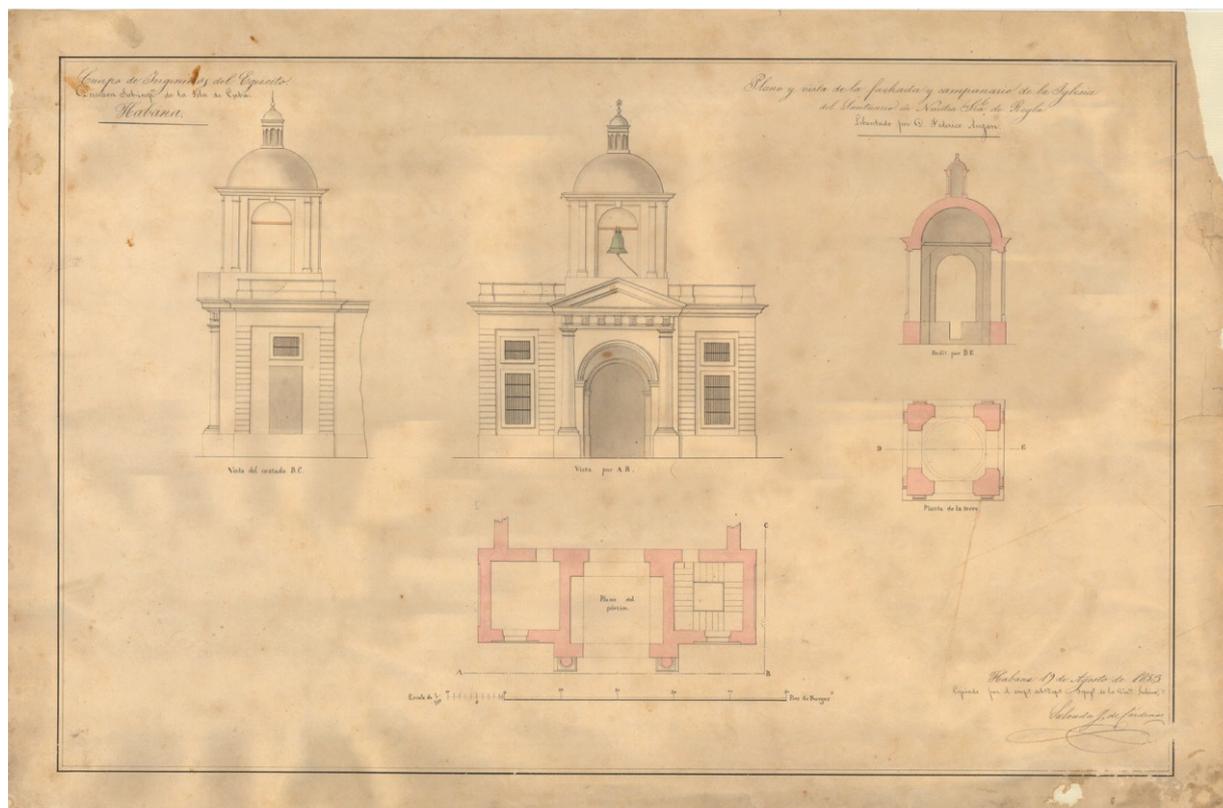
Salvador José Cárdenas. *Plano y vista de la fachada y campanario de la Iglesia del Santuario de Nuestra Señora de Regla. Levantado por Don Federico Augan.* La Habana, 1853. AGM, CUB 194/05.
